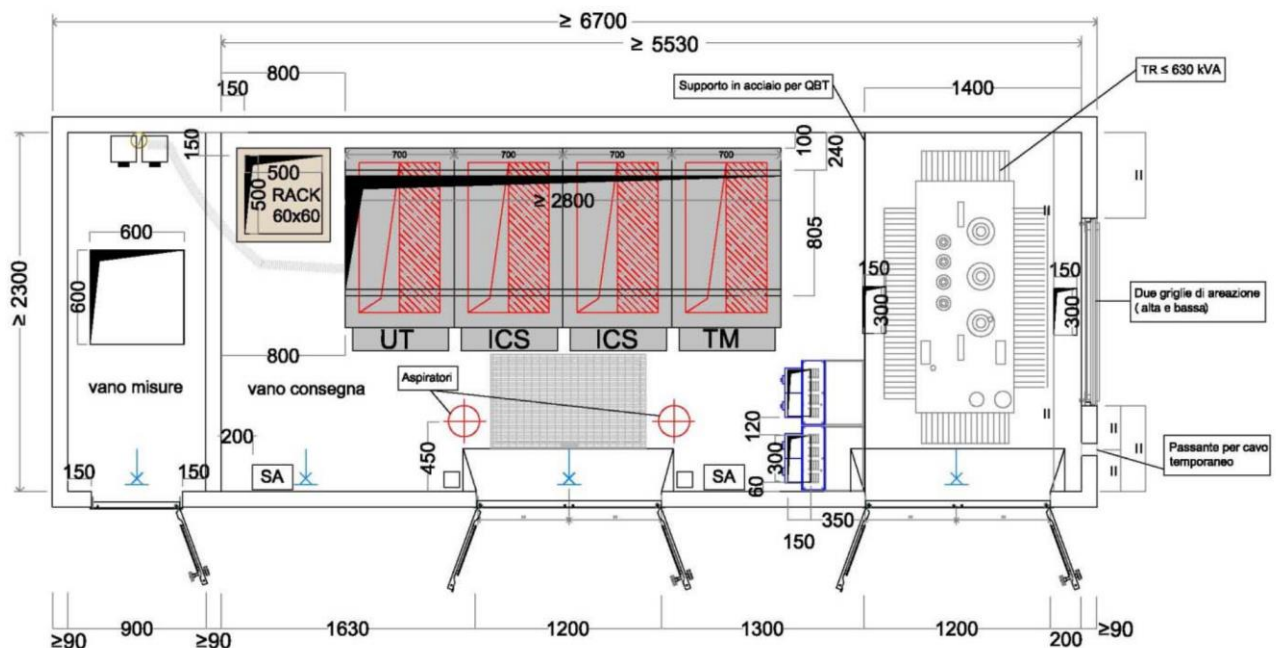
planimetria cabina di consegna (Fonte: DG2092 E-Distribuzione)
